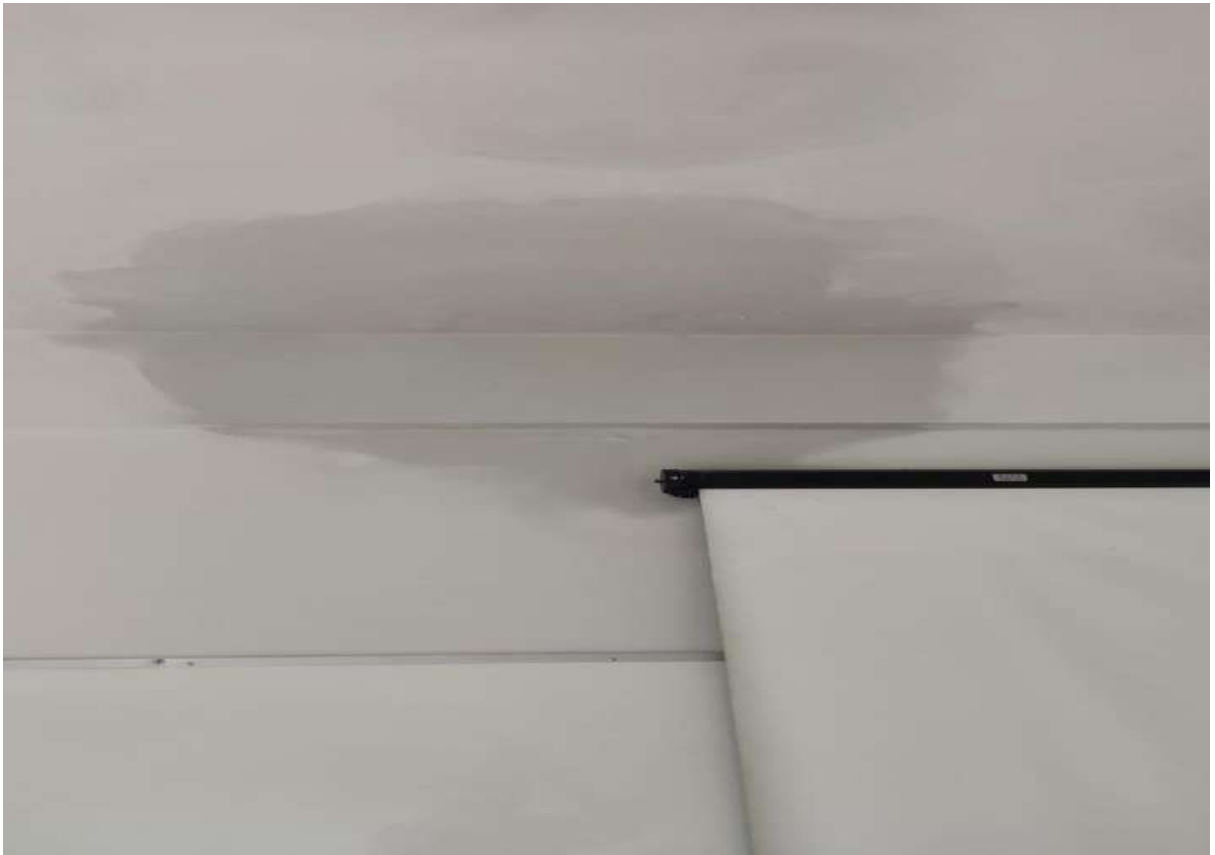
Infiltração na sala de aula no 2º pavimento (Depto Nutrição)
